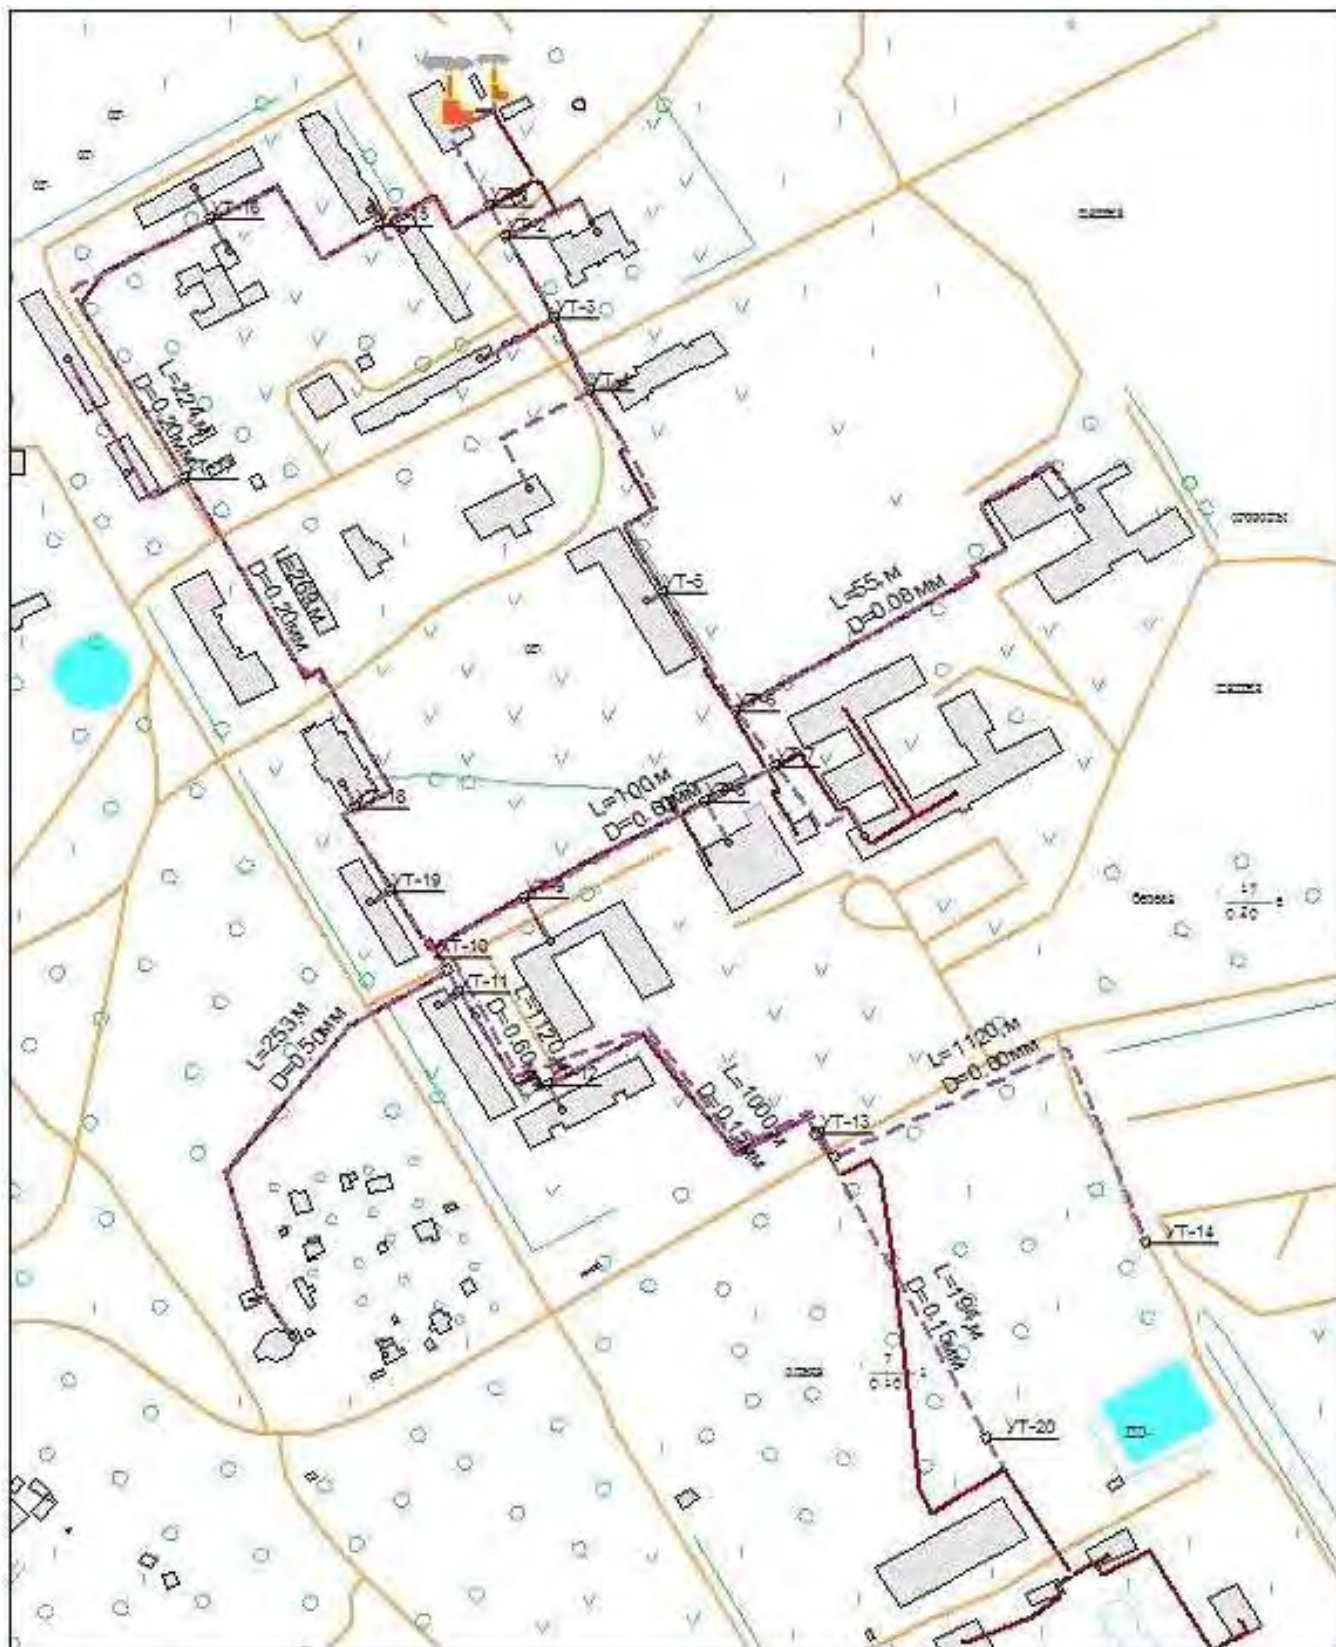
Трассировка планируемой к строительству тепловой сети по Котельной №12
